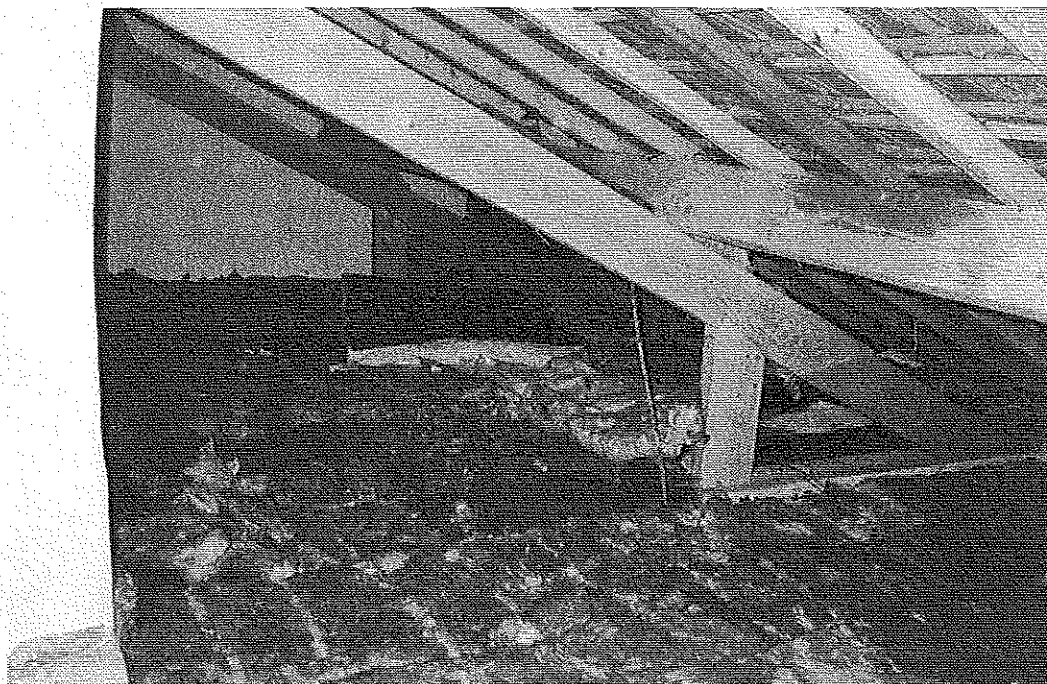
Mise en place de l'isolant récupéré (pare-vapeur en sous-face) sur le plancher du comble.
